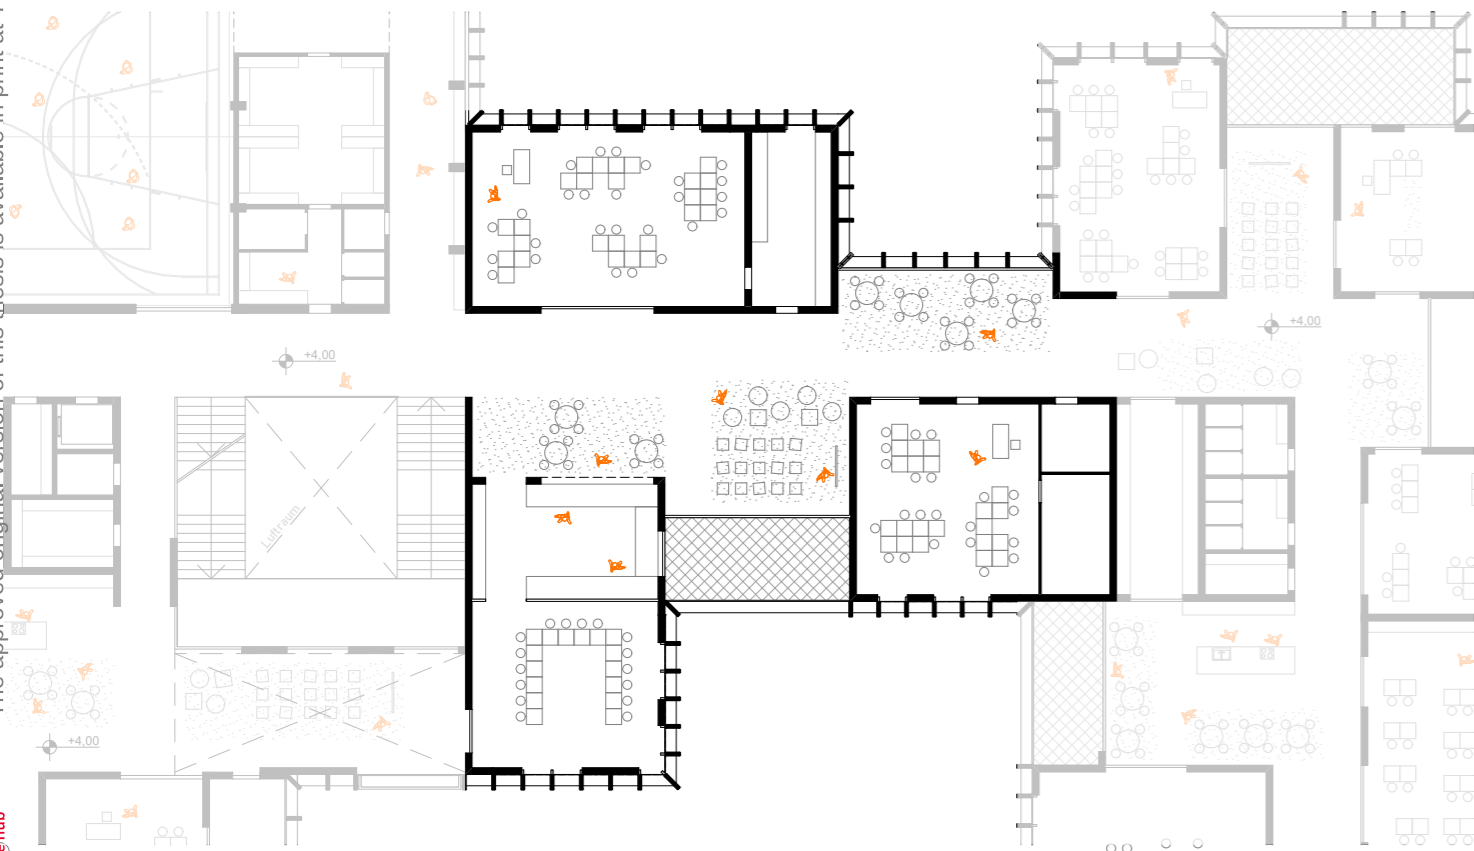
Grundriss Abschnitt-Kreativbereich
